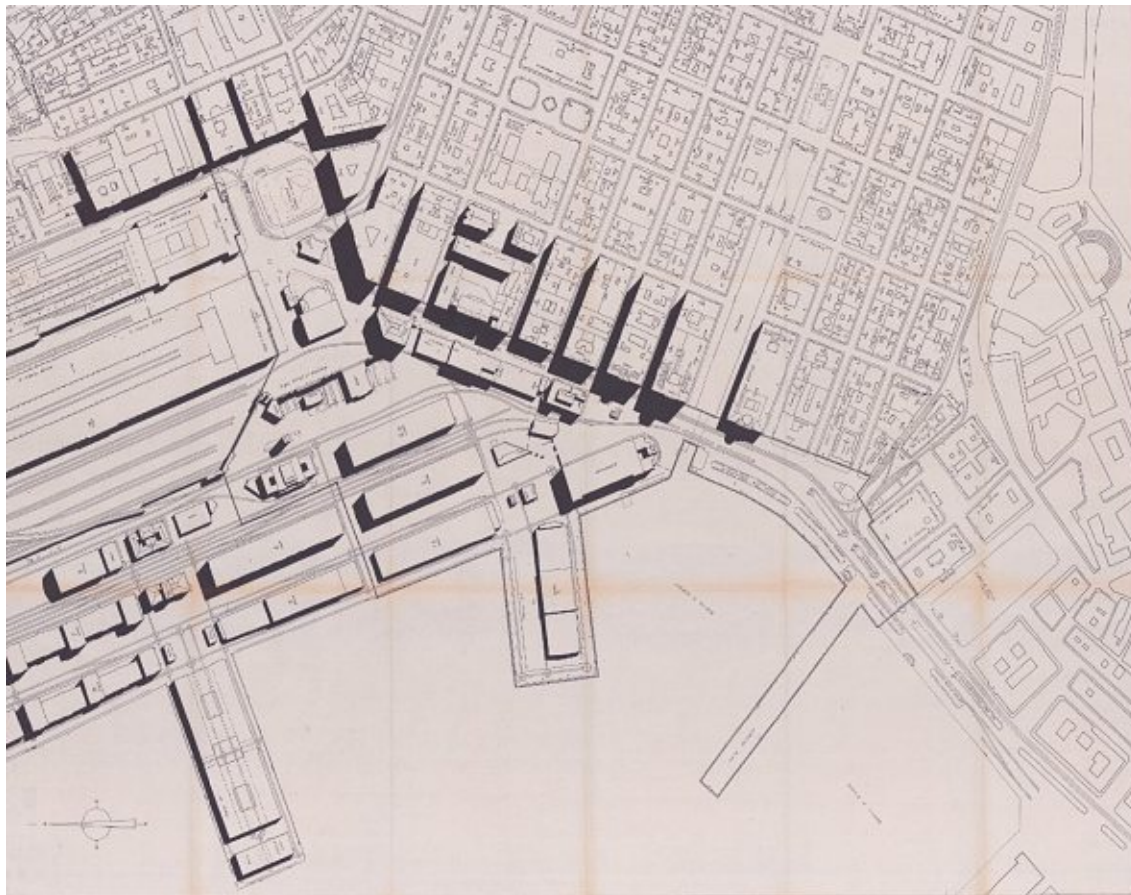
Lageplan des vom Masterplan betroffenen Areals, Gino Valle.
